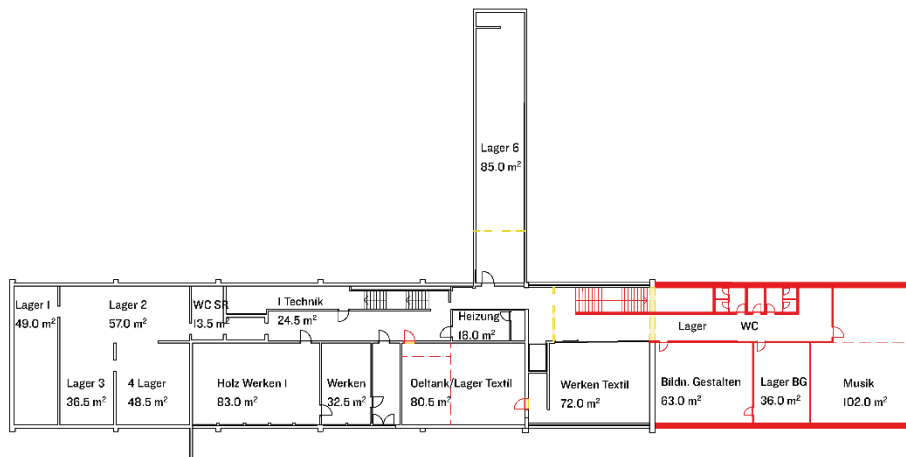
Grundriss Untergeschoss Richtprojekt Oberstufenschulhaus
